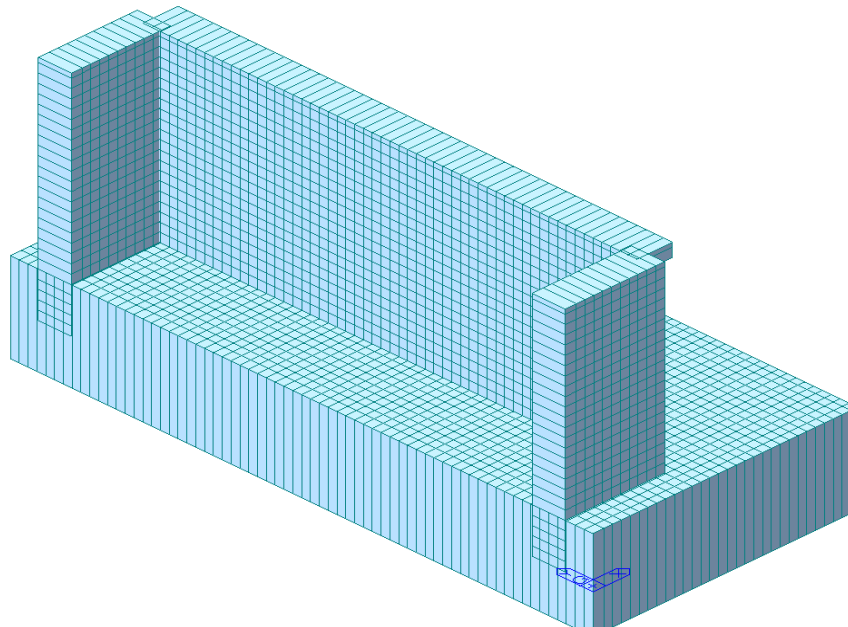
Vista prospettica del modello della spalla A
